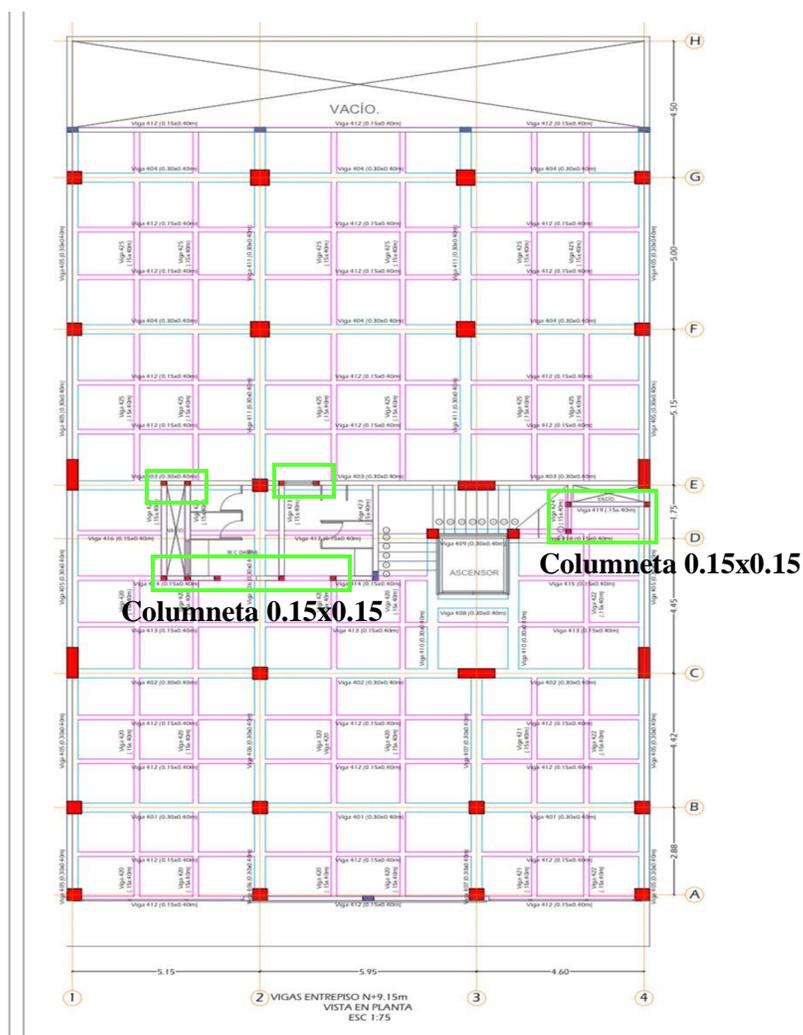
Vigas, columnas Y columnetas vista en planta.
